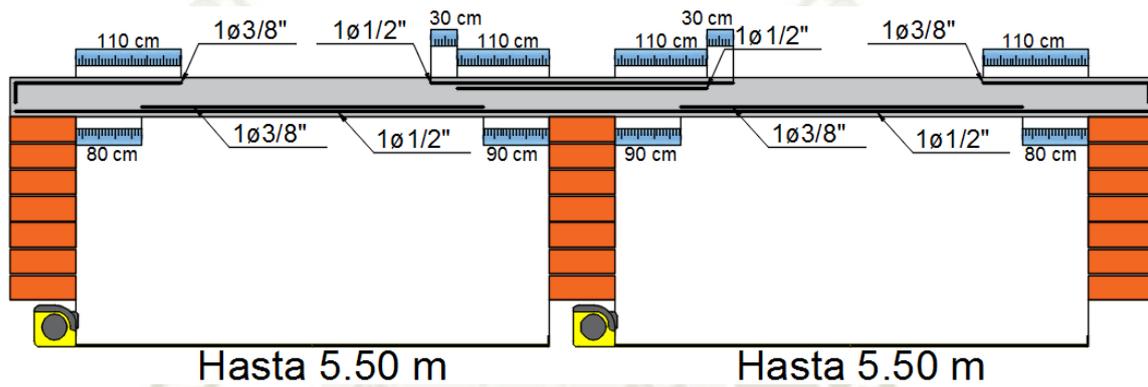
Refuerzo de vigueta hasta 5.50 m por tramo.
